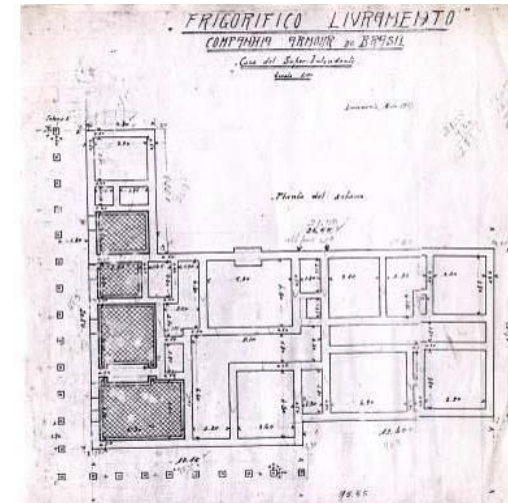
Planta térreo, desenhista Donineli, maio de 1917.
